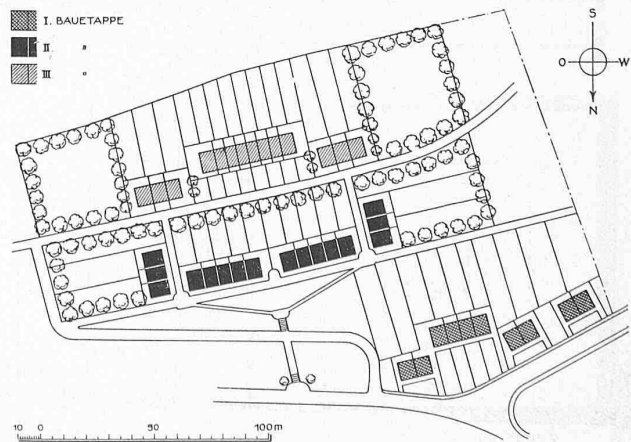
Wohnkolonie Friedberg, Luzern. — Lageplan 1 : 3000.
